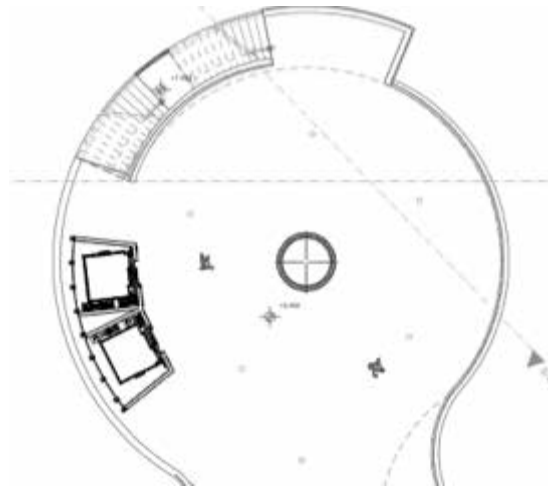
Plaza de acceso 4, planta 1. (+5.45m) (2017)
